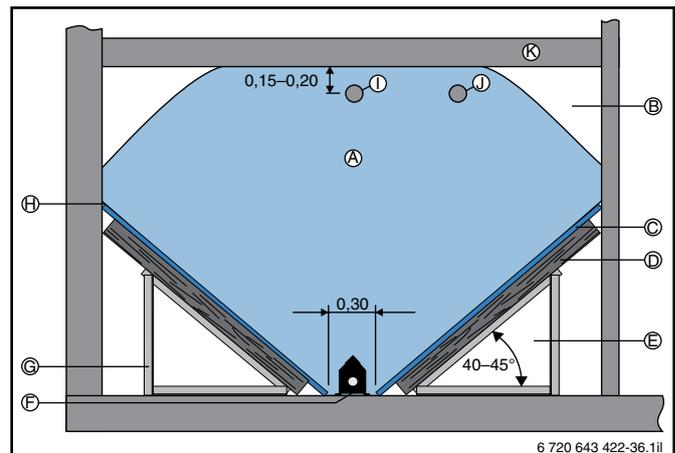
Sezione di un pavimento inclinato (quote in m)
